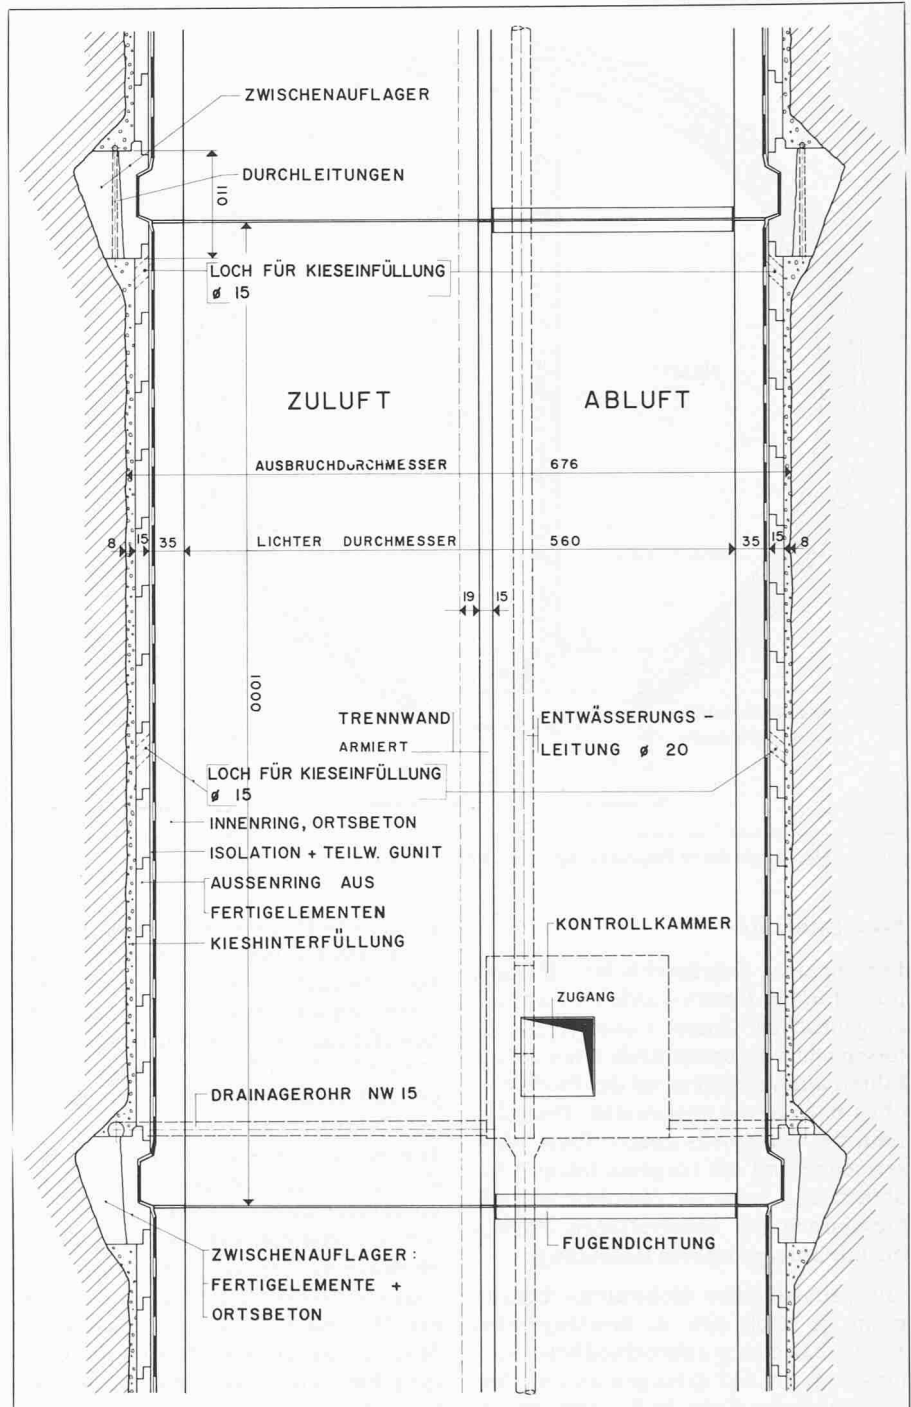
Lüftungsschacht Hospental, Normalelement, Vertikalschnitt
